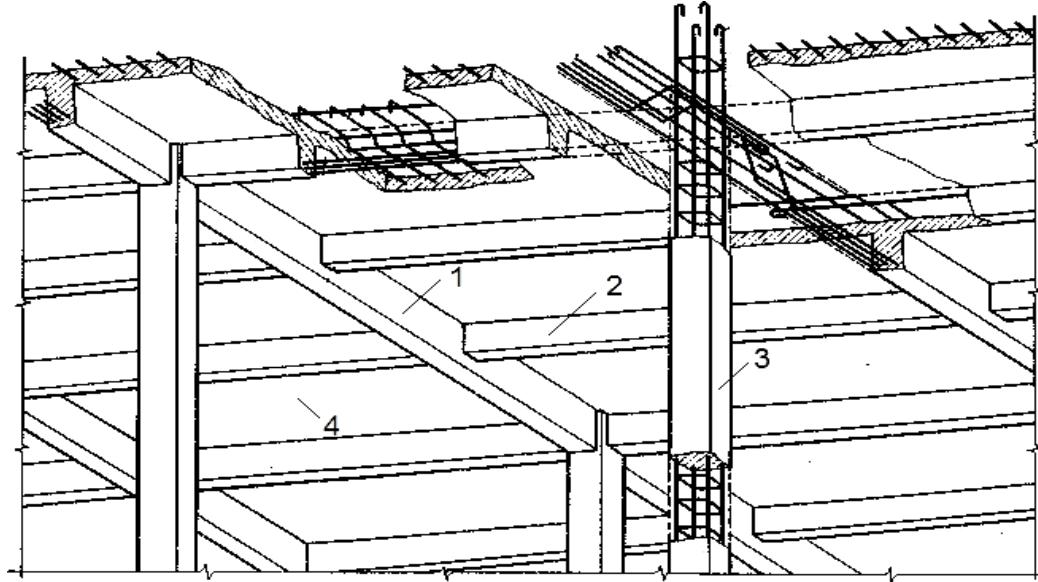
Монолитное ребристое перекрытие с балочными плитами:
